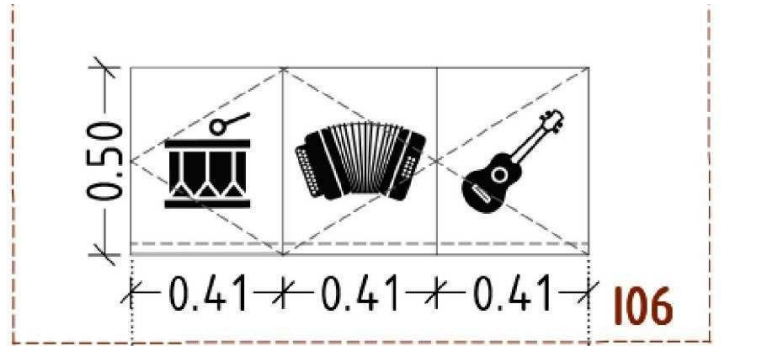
Recorte de vinil aplicado nos armários da casa de banho
